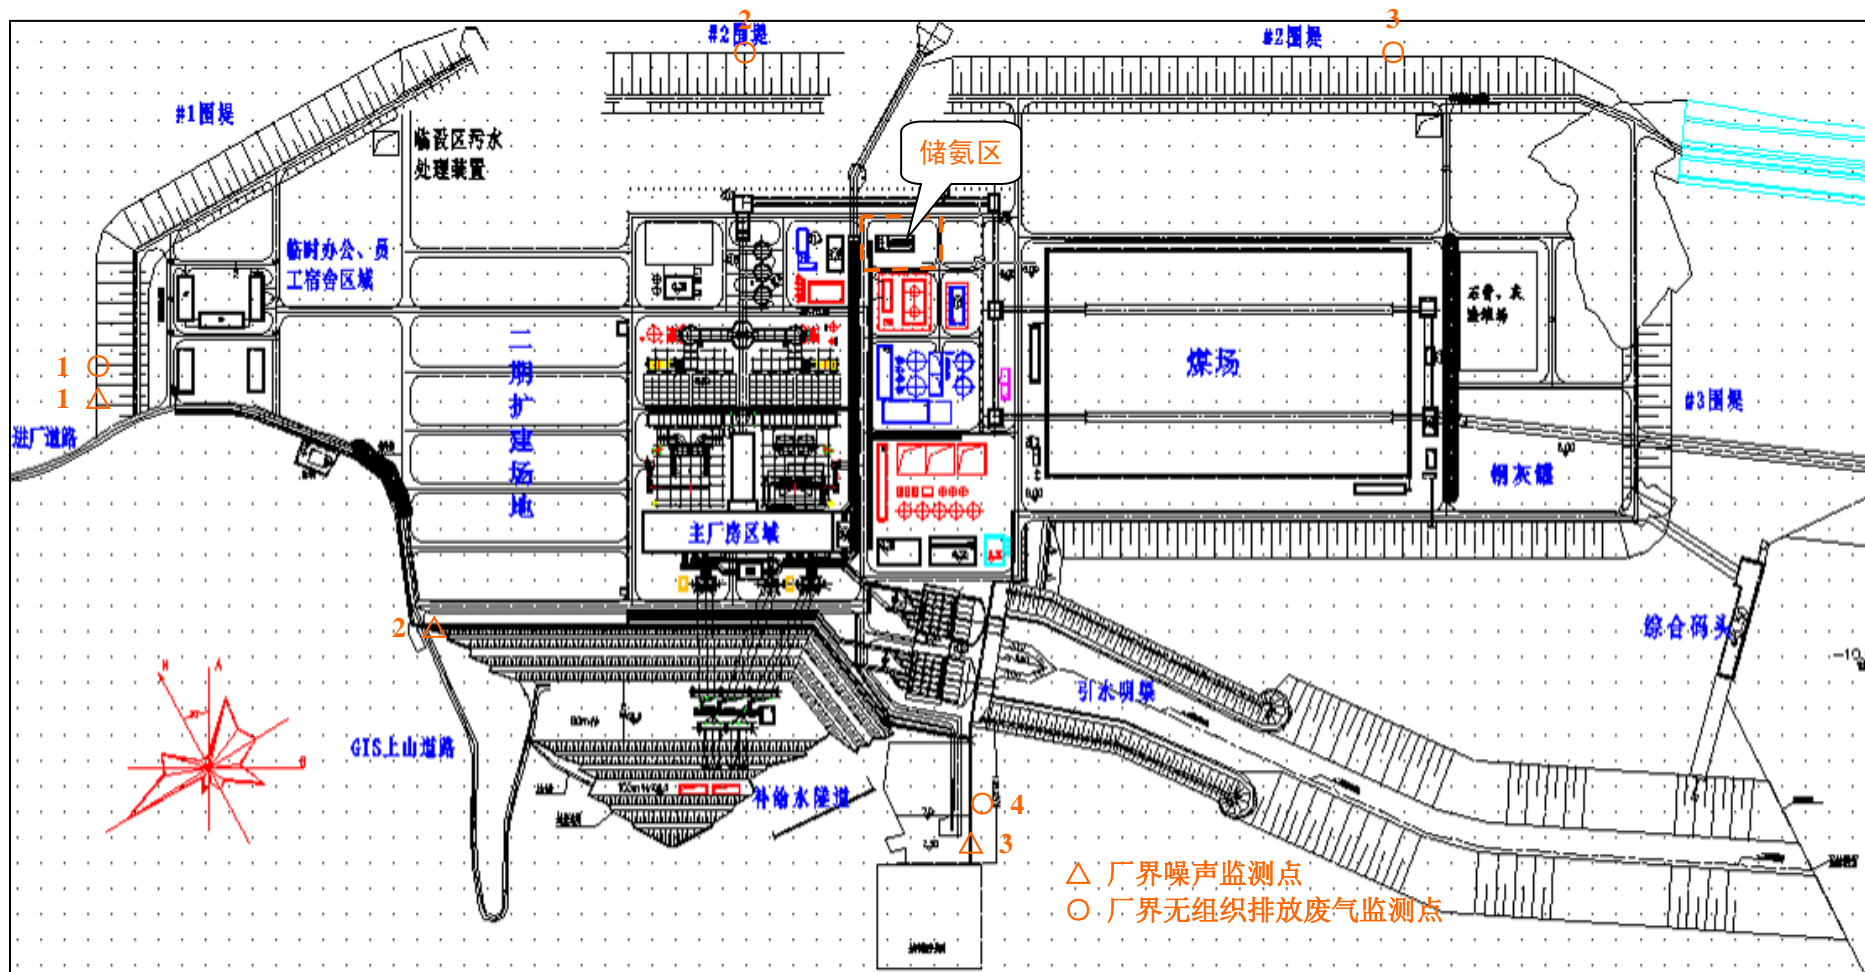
公司厂区总平面布置图（一）和厂界监测点位示意图
